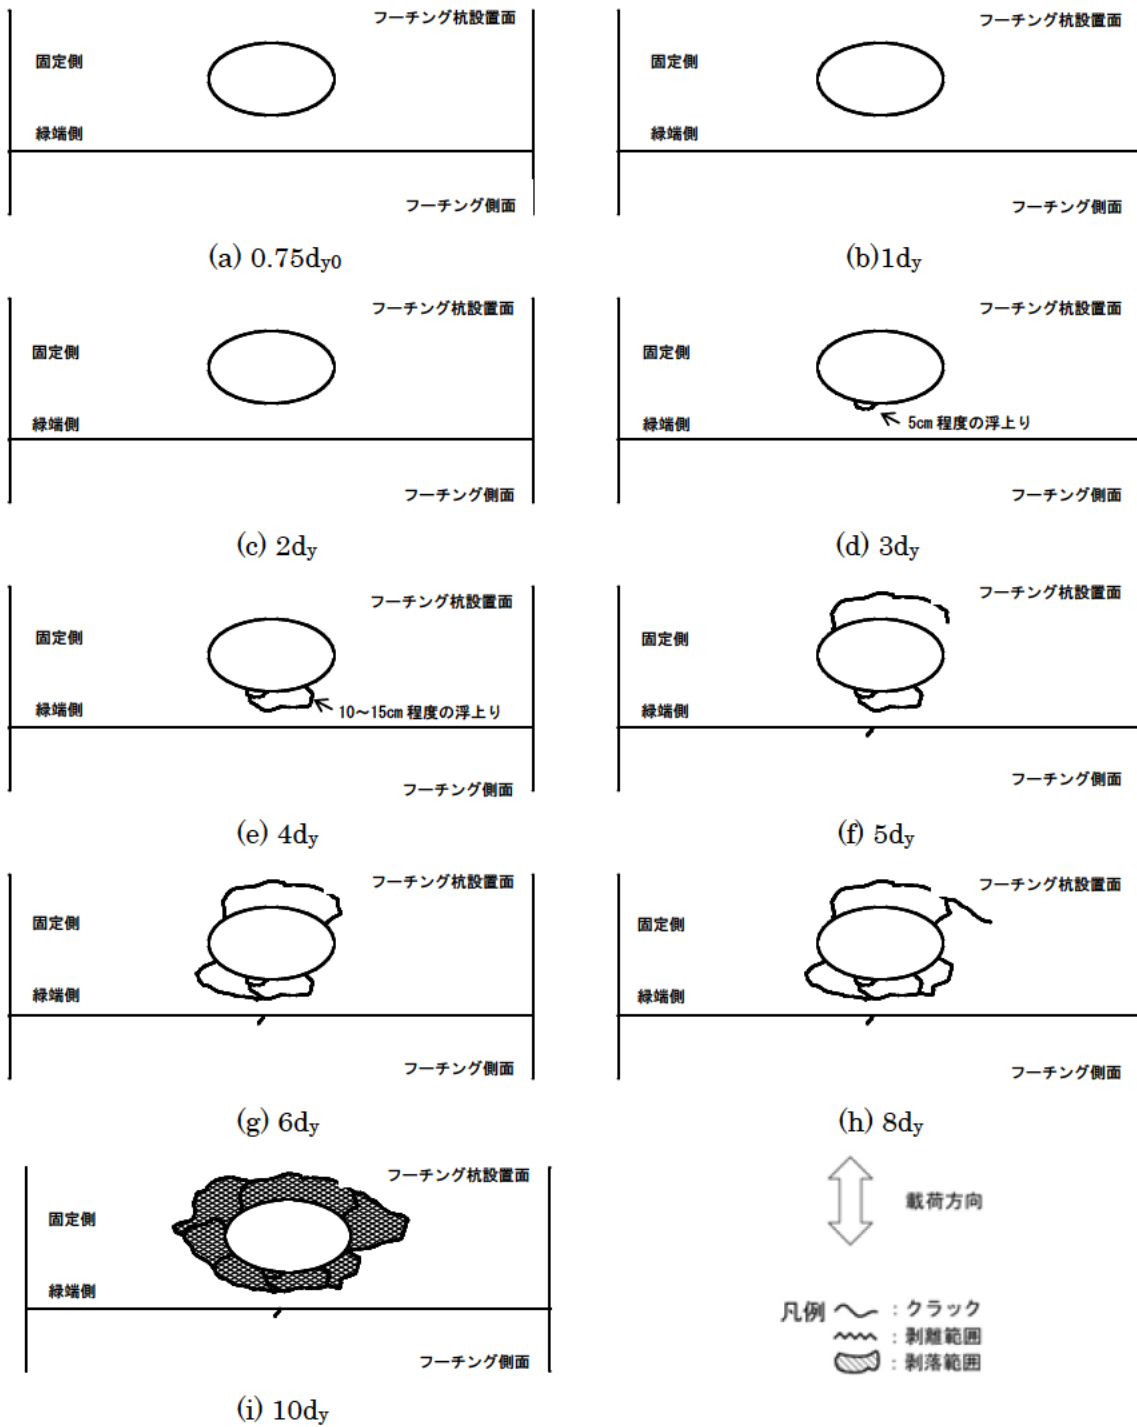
杭設置面フーチングのひび割れ進行状況図 (Case CPP-S-1)
